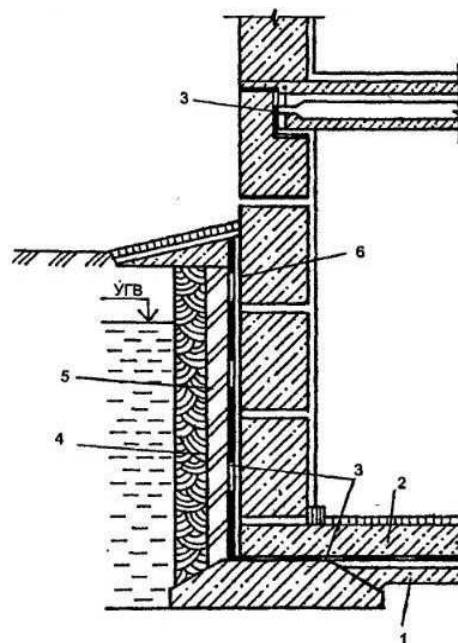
Конструкція стрічкового фундаменту з підвалом. 1- бетонна основа; 2- залізобетонна плита; 3- рулона гідроізоляція; 4-м'ята глина; 5- фундамент; 6- слой бітума
